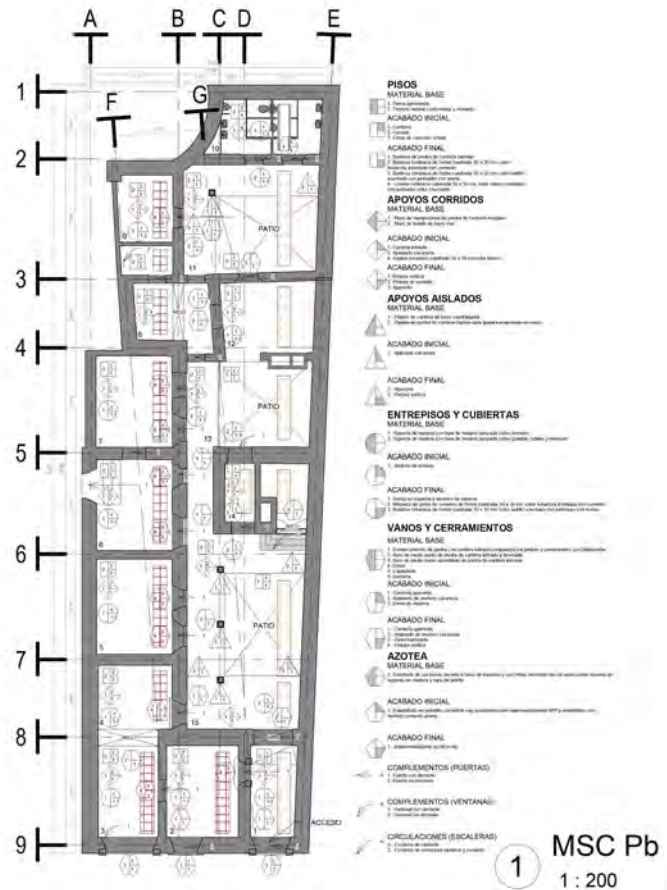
Simbología aplicada en los planos de registro de materiales y sistemas constructivos. Plano CAMEM MSC 100. Planta baja Elaboró: METR
